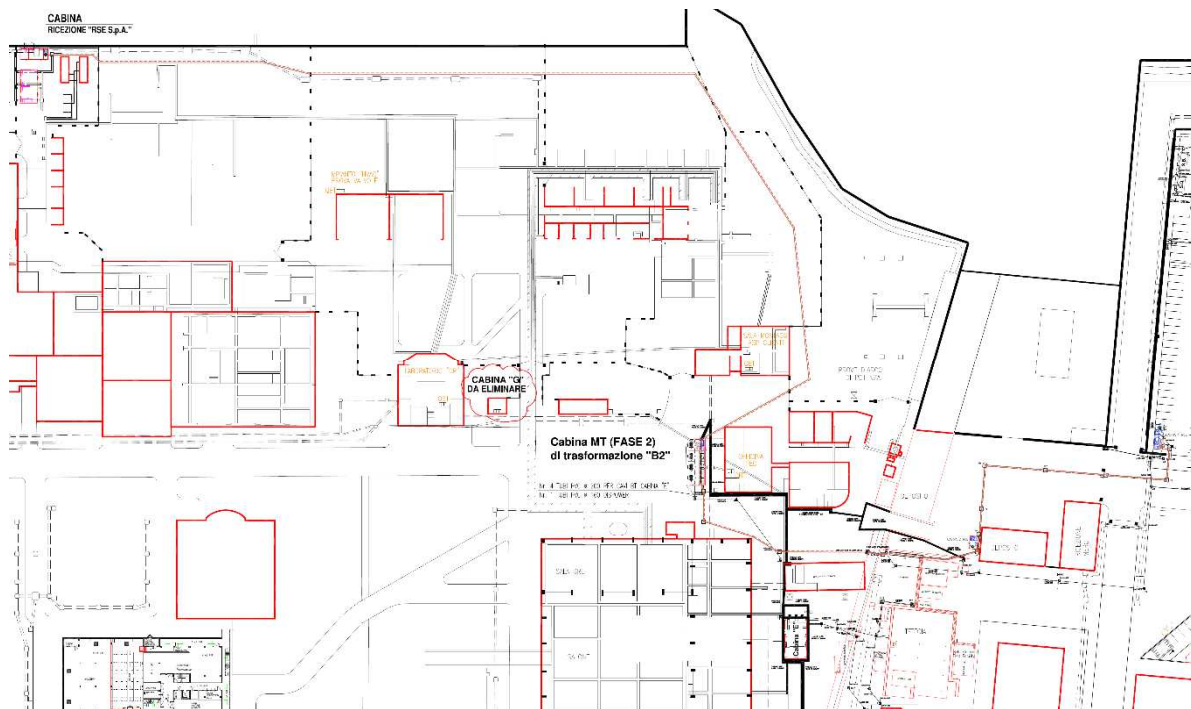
Disposizione planimetrica generale dell'impianto MT e SCADA.
